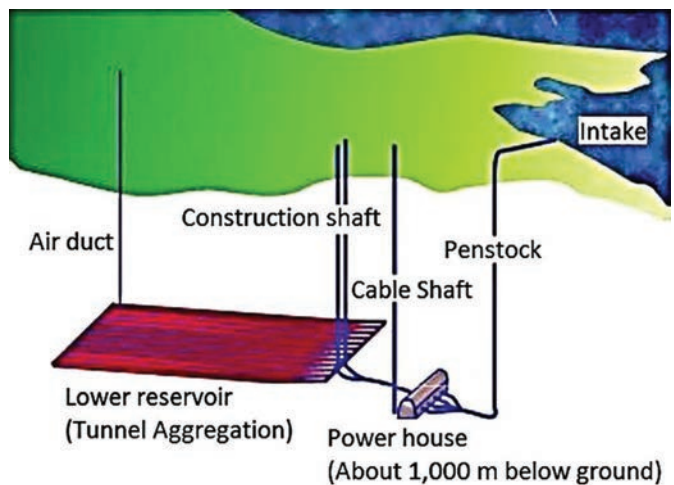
Схема гидроаккумулирующей электростанции с подземным расположением нижнего резервуара: air duct — вентиляционный ствол, lower reservoir (tunnel aggregation) — нижний резервуар (комплекс туннелей), construction shaft — ствол для строительства, cable shaft — кабельный ствол, power house (about 1 000 m below ground) — машинный зал (около 1 000 м под землей), intake — вход морской воды, penstock — напорный туннель.
